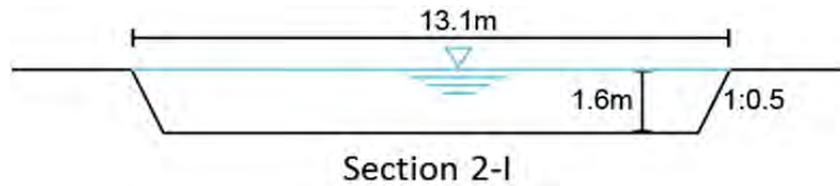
Situ Sidomukti 上流区間 計画横断面図
